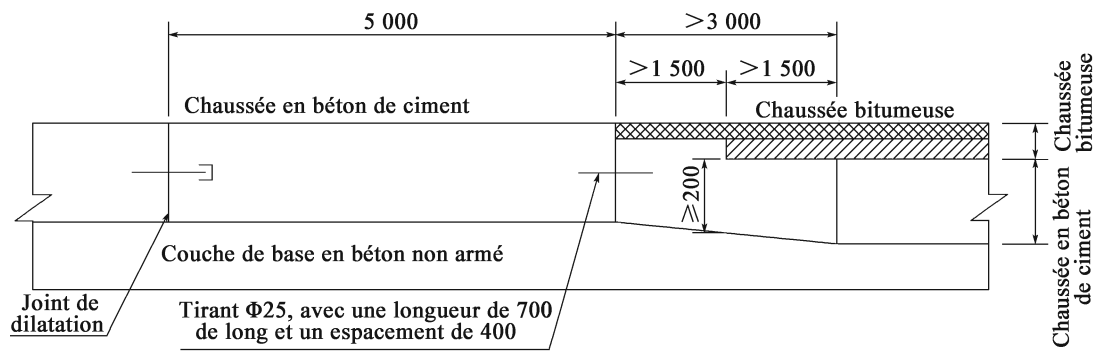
Section de transition entre la chaussée en béton et la chaussée bitumineuse (unité: mm)
